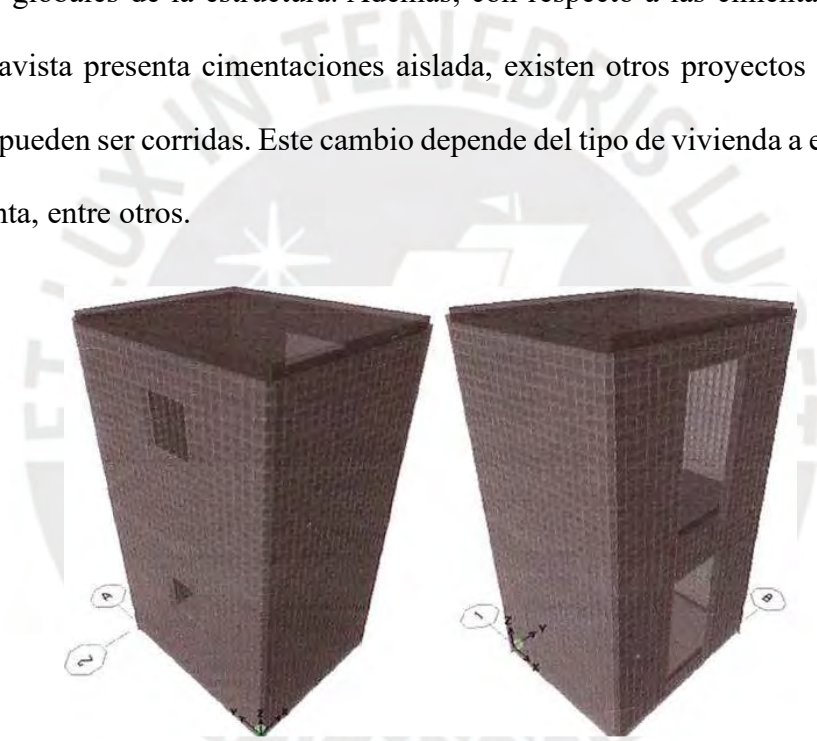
Vivienda Upcrete (2.00 x 2.40 m) ensayada en Laboratorio PUCP
